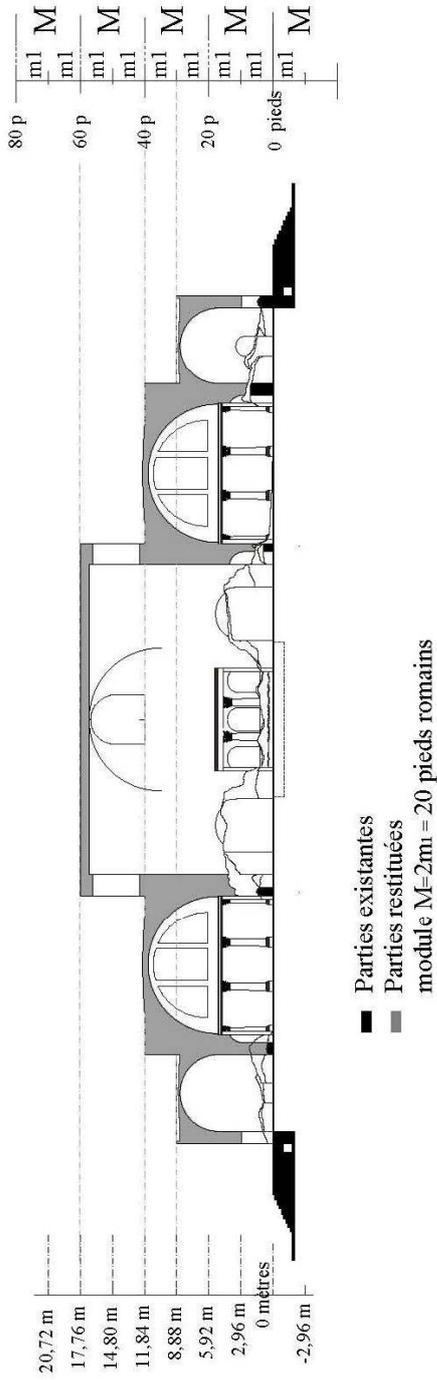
, b Restitution du plan des Grands thermes Nord de Timgad. (Retravaillée sur le plan de Krencker)
